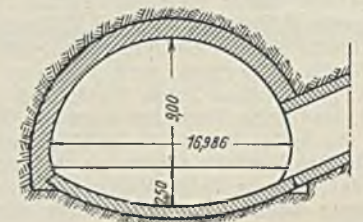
Querschnitt durch die Tunnelstation an der Mündung eines Schachtes.
